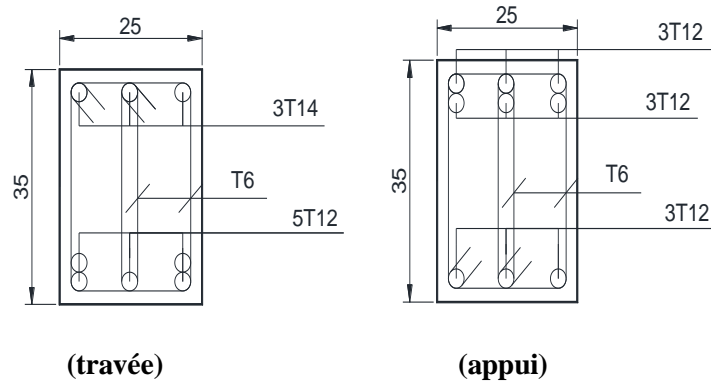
Ferrailage d'une poutre principale 25x35cm (bâtiment R+3)
